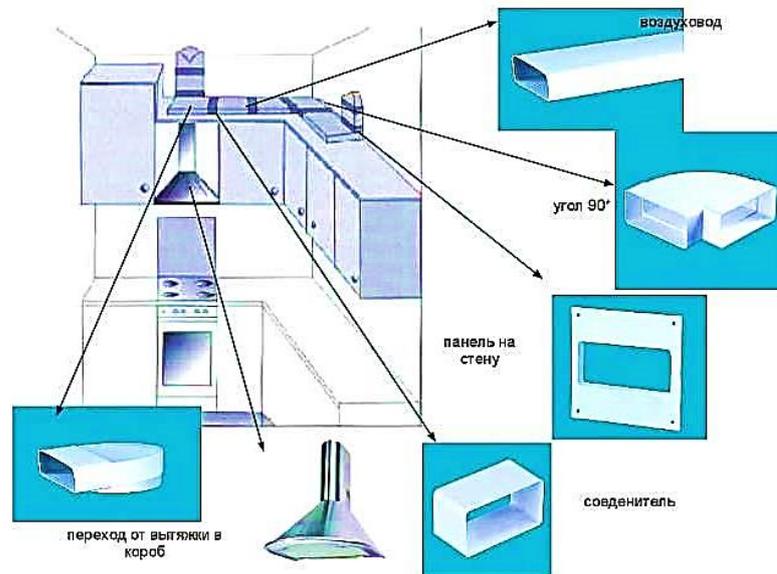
Пластиковые воздуховоды для бытовых систем вентиляции.
